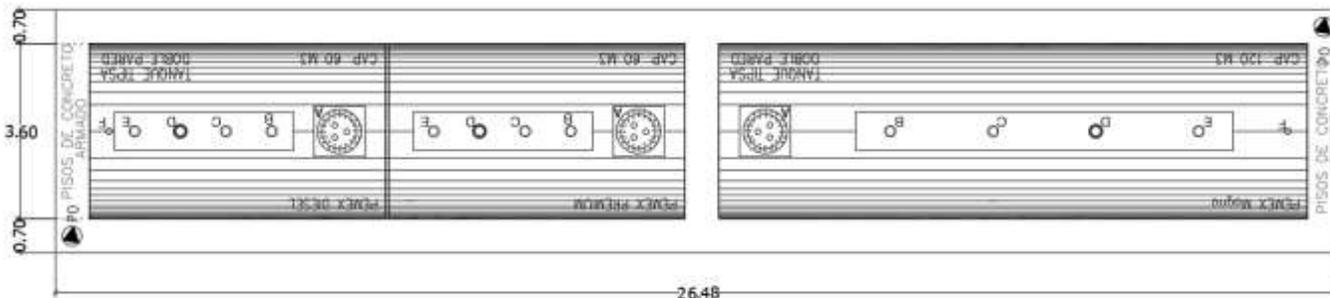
Detalle de Fosa de Tanques de Almacenamiento. (Vista en Planta)
